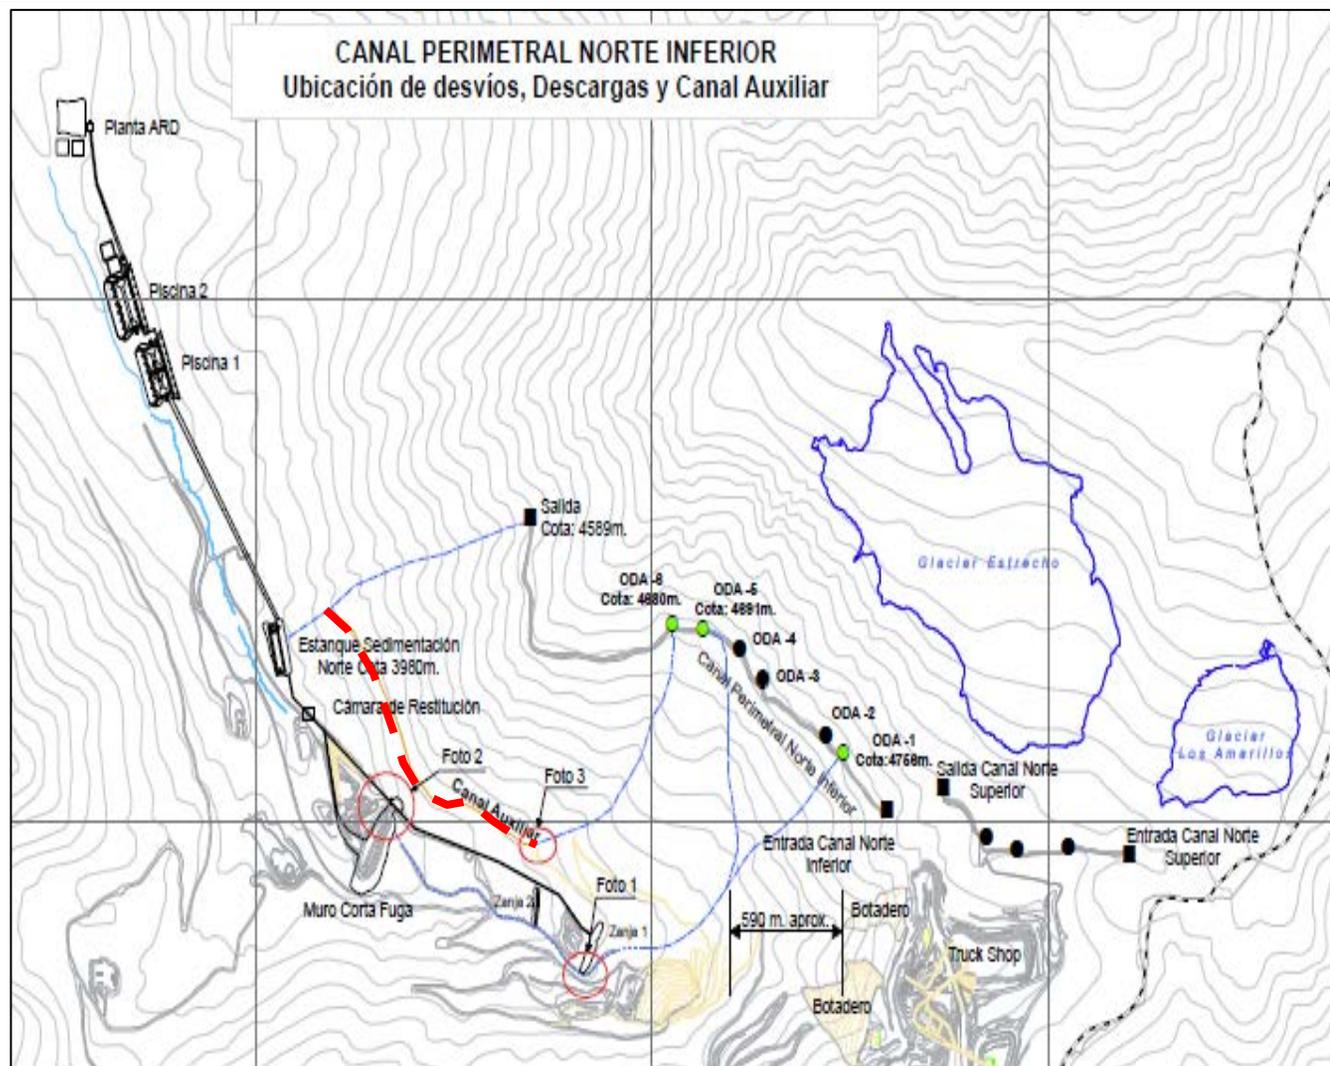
Planimetría CNPI actual (Fuente: Barrick, 2013)
